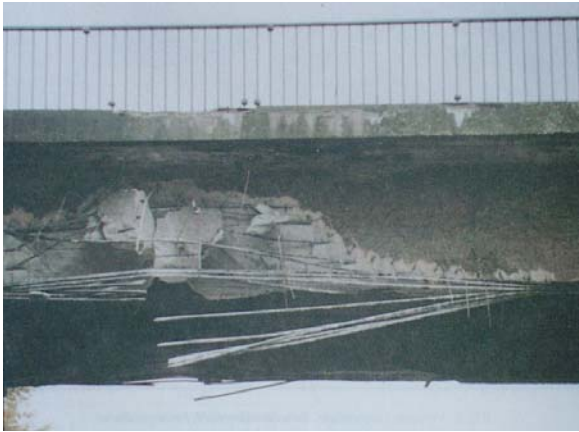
Ausgerissene Bewehrung [13]
